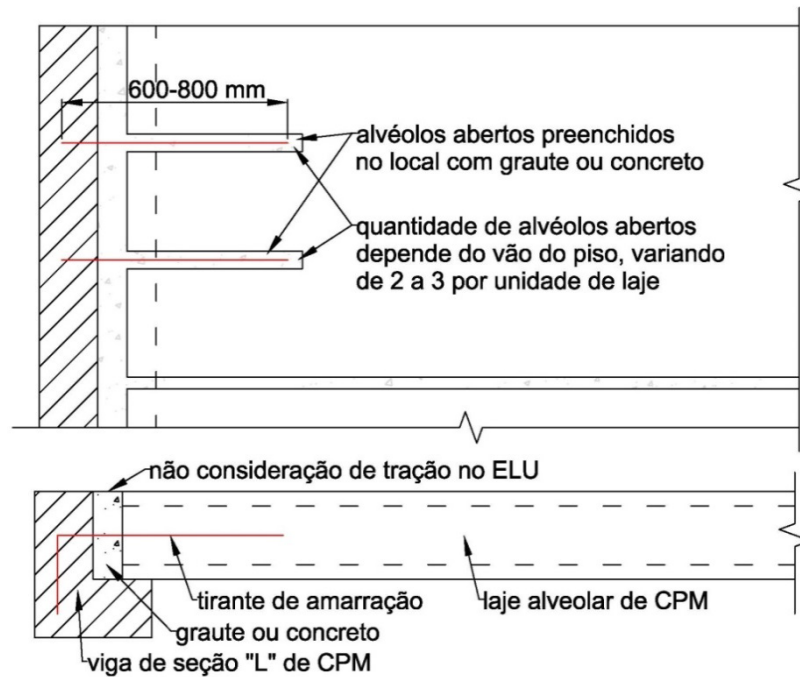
Ligação viga-laje com restrição parcial à rotação do piso [adaptado de Elliott (2002) e FIB (2008)].
